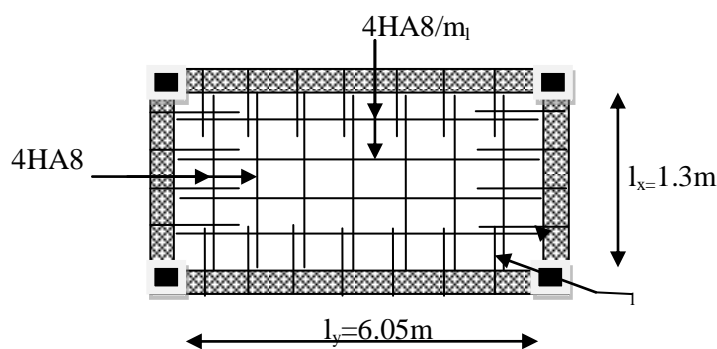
schéma de ferrailage de la dalle sur 4 appuis.
